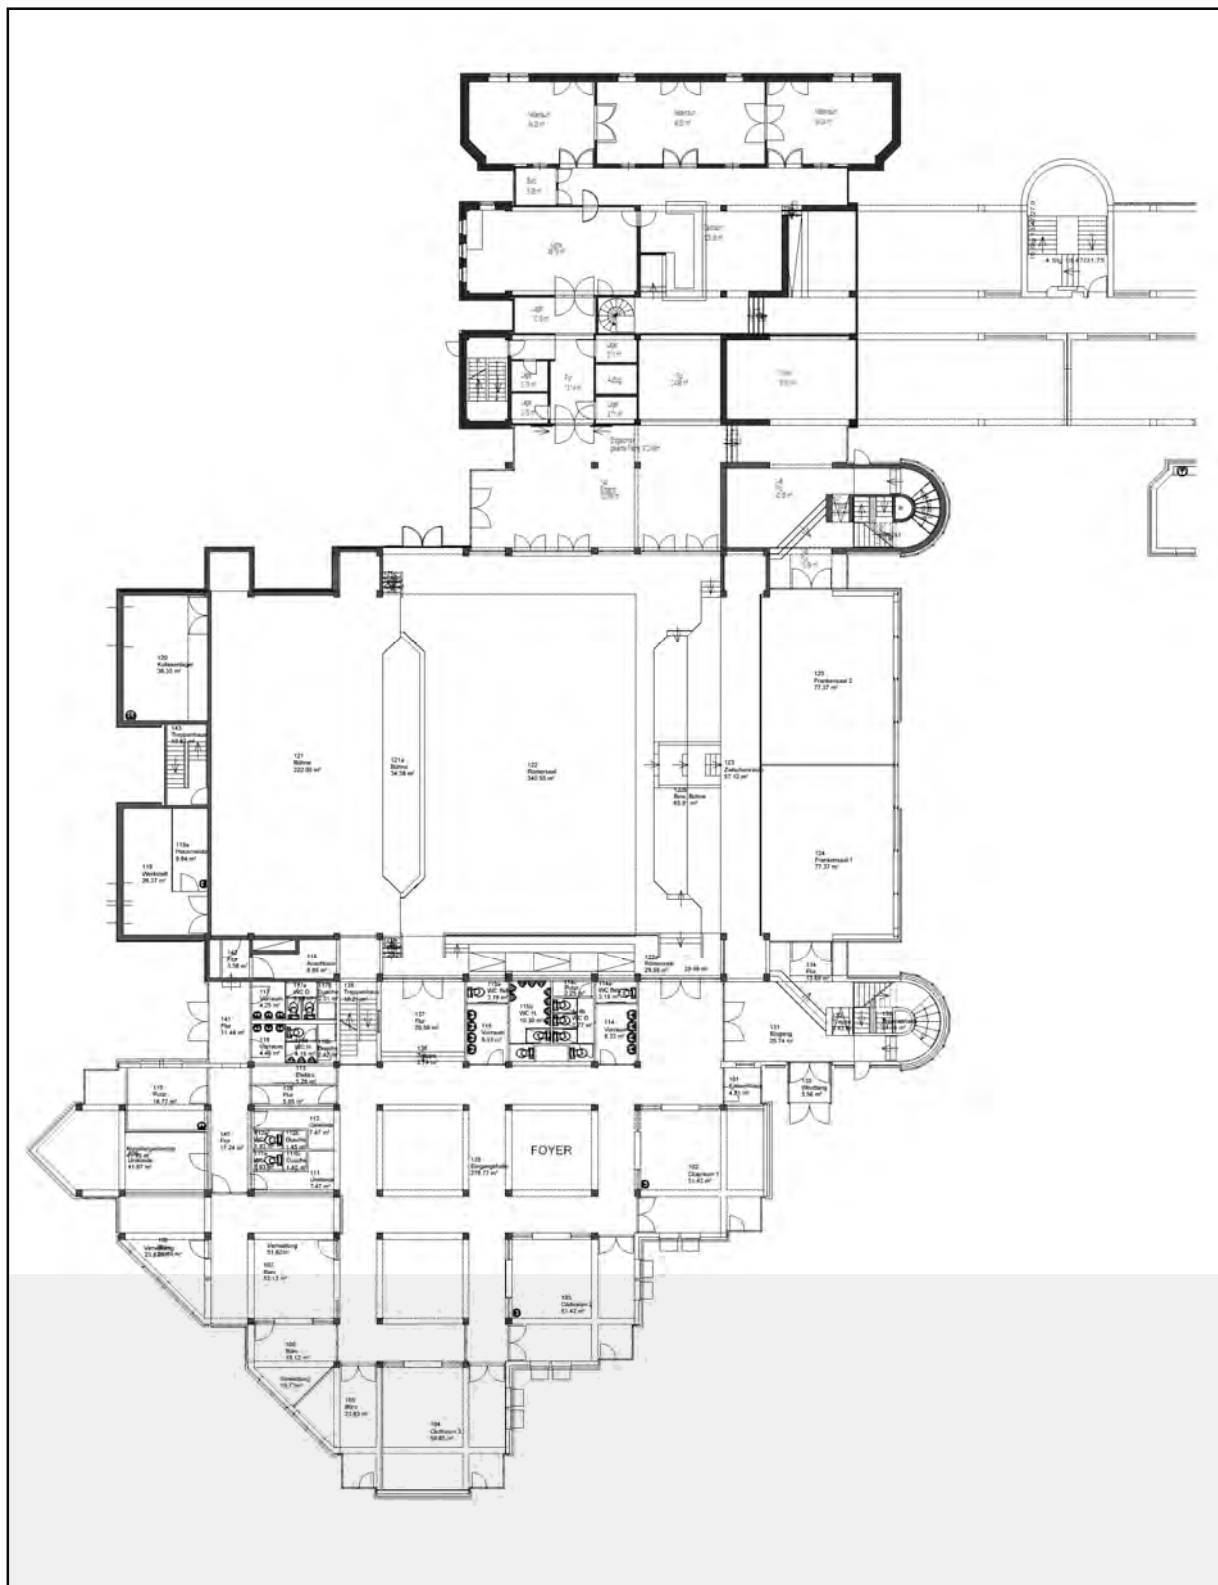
Bürgerhaus: Grundriss 1. OG
